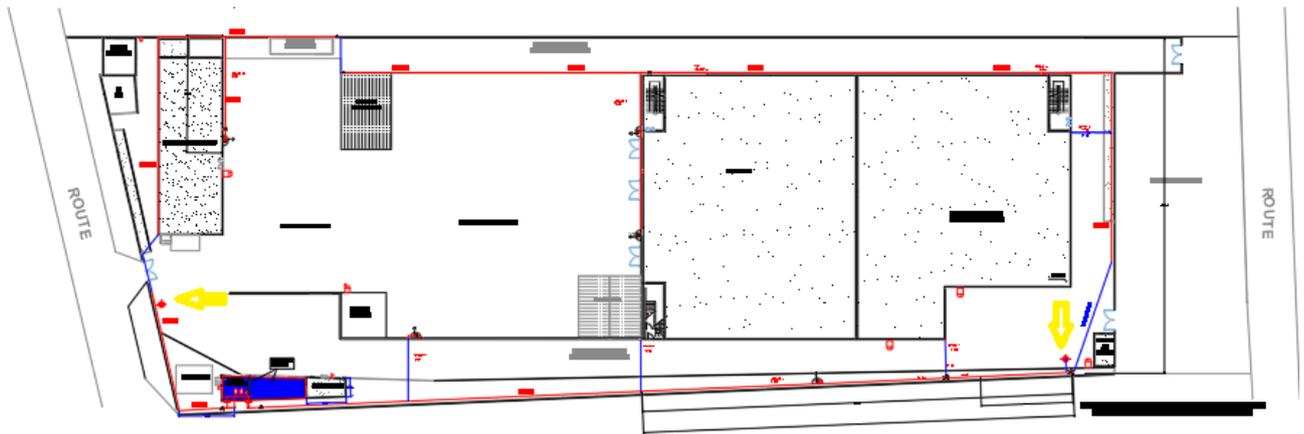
Représentation des poteaux d'incendie sur le plan général du site.
